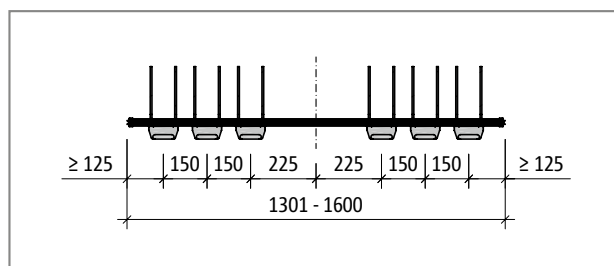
Schöck Tronsole® tipo T-V6-H...-L1301 - L1600, pianta del prodotto
